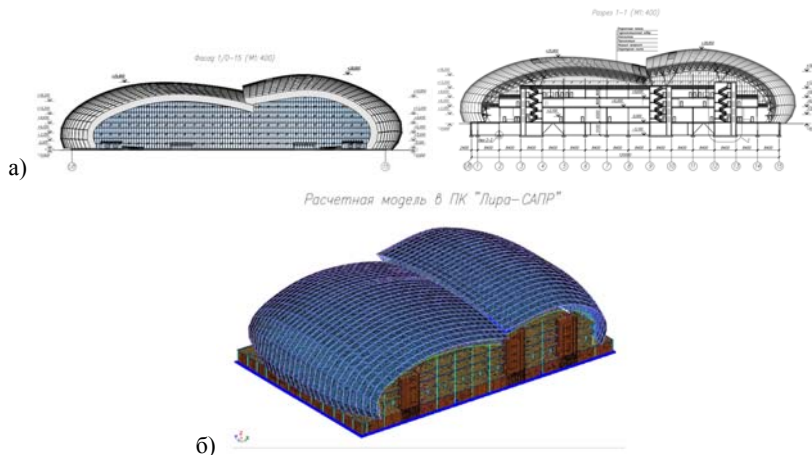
Дипломный проект на тему «Дворец водных видов спорта с покрытием в виде криволинейной оболочки»: а) фасад и разрез здания ДВС; б) расчетная схема оболочки
